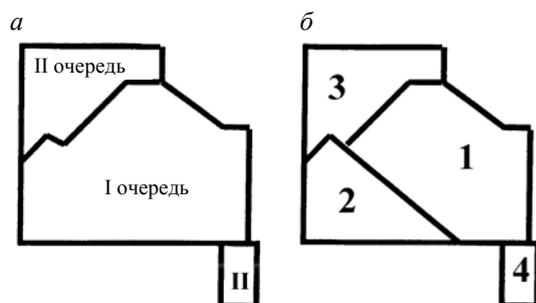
Части здания: а – очередность строительства; б – плиты фундамента
